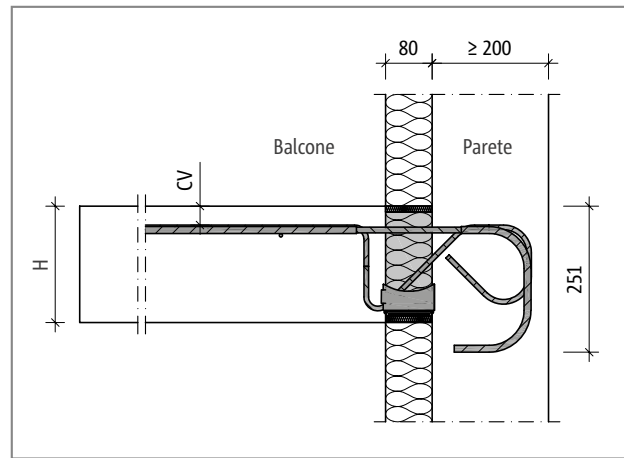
Schöck Isokorb® T tipo KL-O-M8 – KL-O-M12: raccordo alla parete con isolamento esterno
